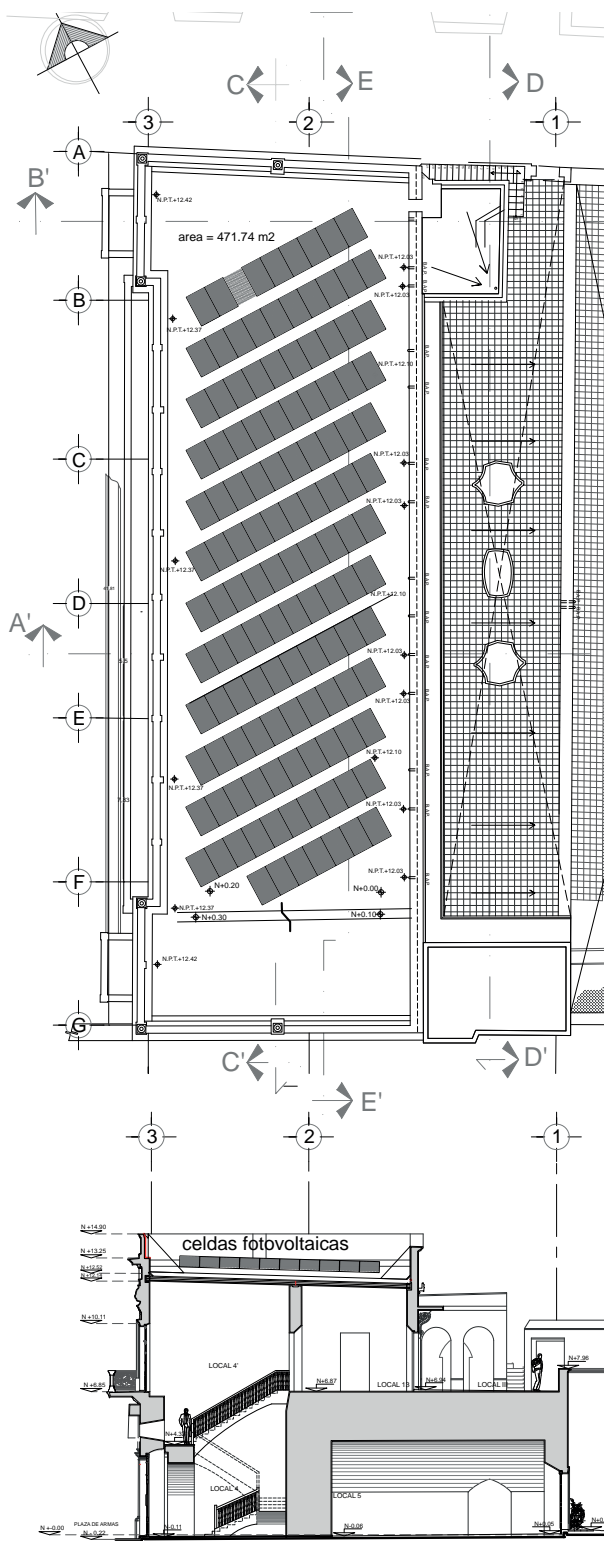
Distribución de los paneles solares en la azotea de la casa del Gobernador. Planta y corte.
